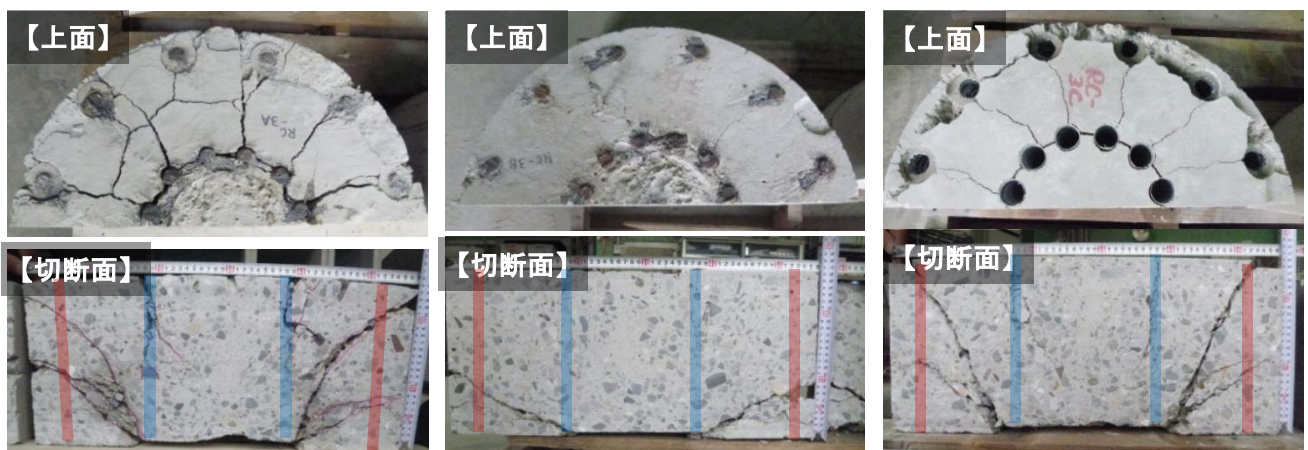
試験後の試験体中心の切断面 (左: 試験体 1, 中: 試験体 2, 右: 試験体 3)
